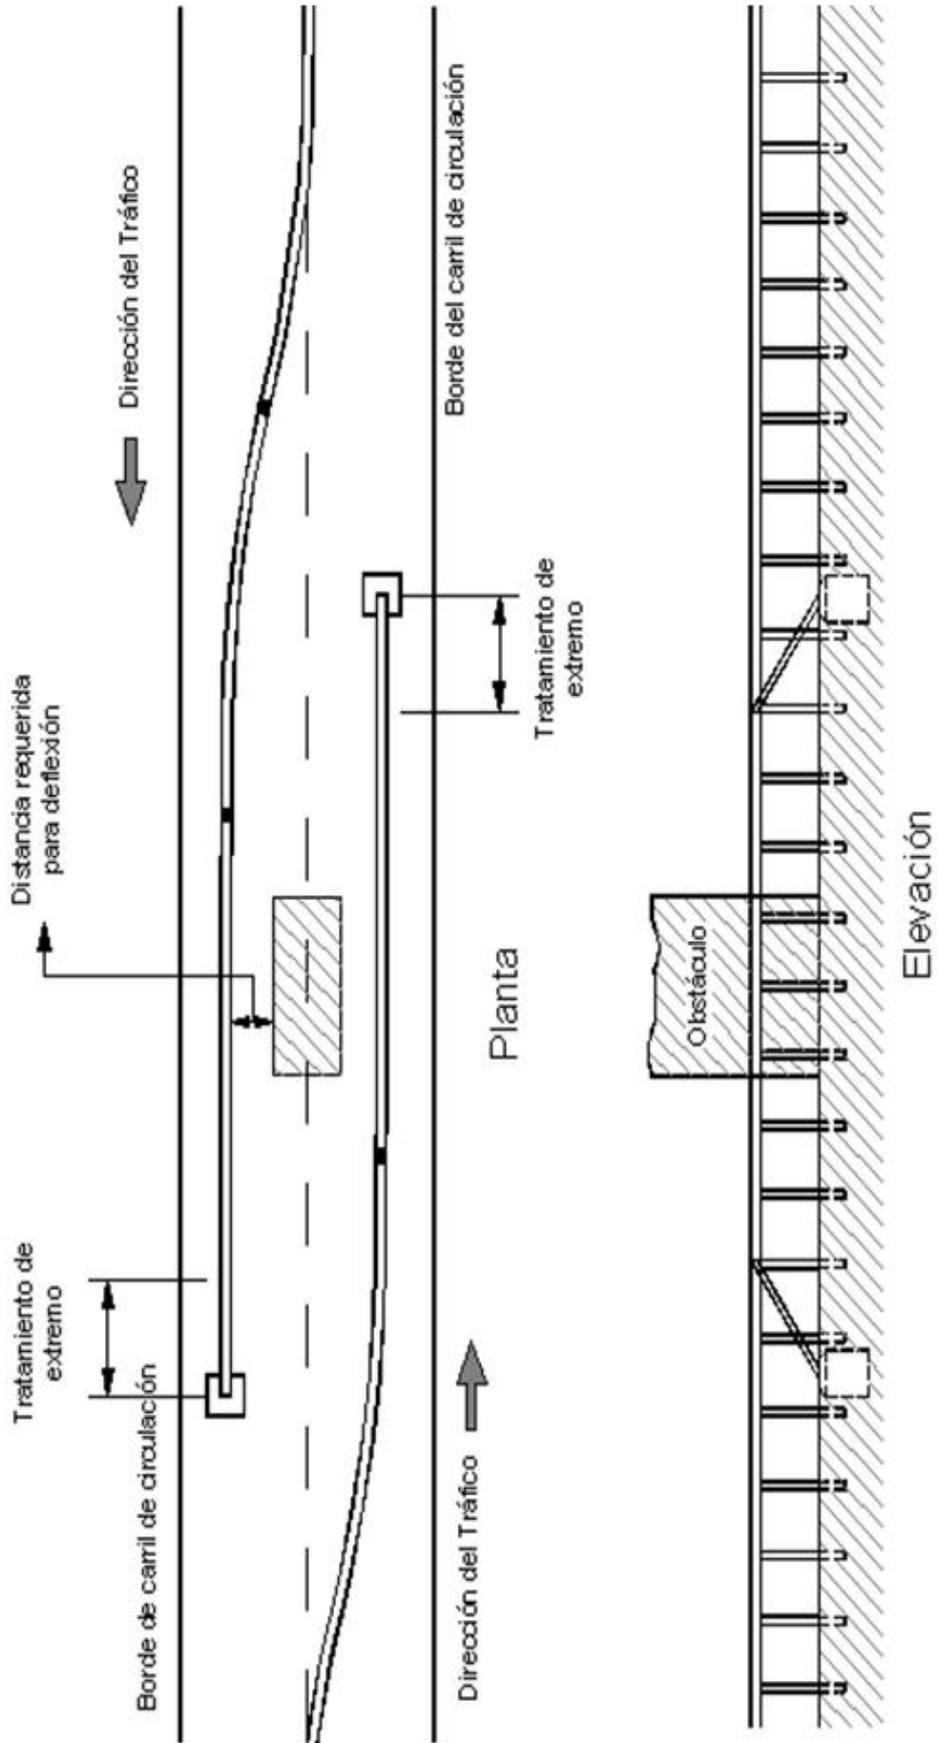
TRATAMIENTO DE OBSTÁCULOS CON BARRERA DE VIGA CAJÓN EN SEPARADOR CENTRAL
